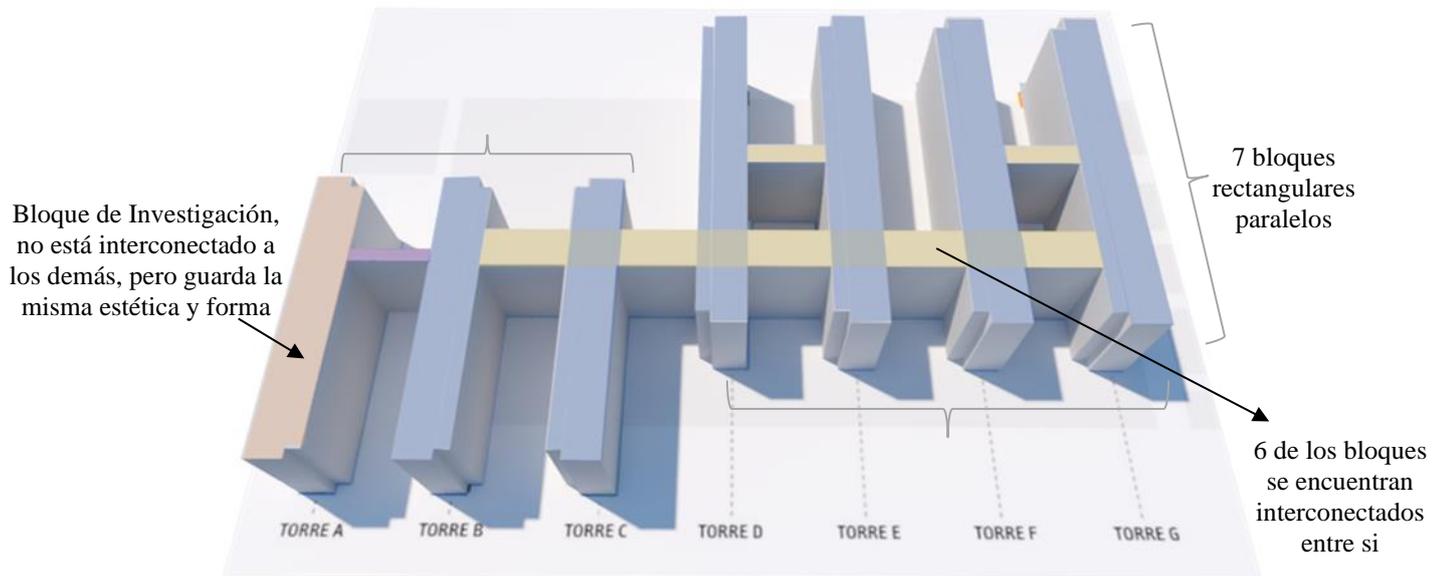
Boceto de fachada de caso 6. Fuente: Elaboración propia
